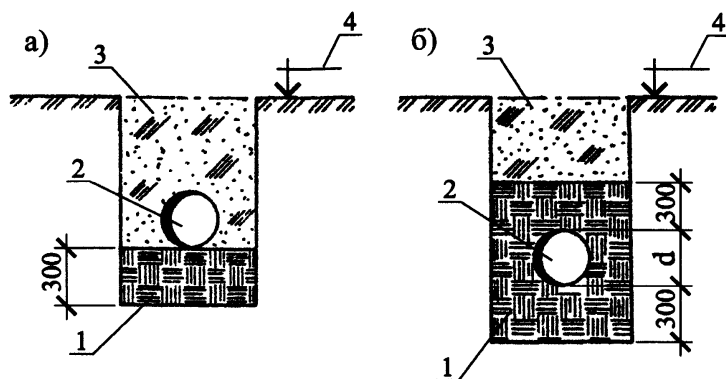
Гидроизоляция трубопроводов (водопровода и канализации) при бесканальной прокладке
